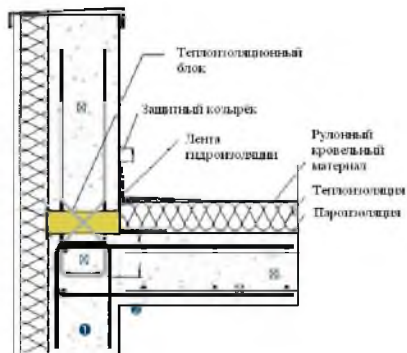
Несущий теплоизоляционный блок расположенный в узле «наружная стена – плита перекрытия – парапет»
